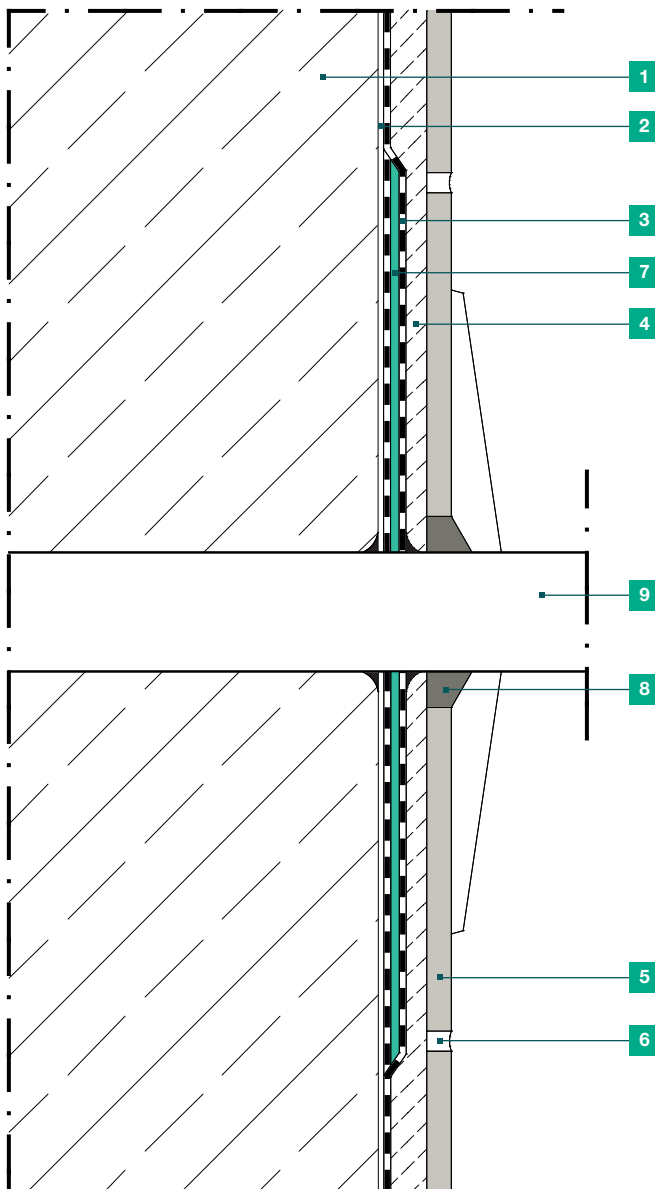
Rohrdurchführung mit Dichtmanschette - Abdichtung mit DICHT DA-P/FDS 1K
